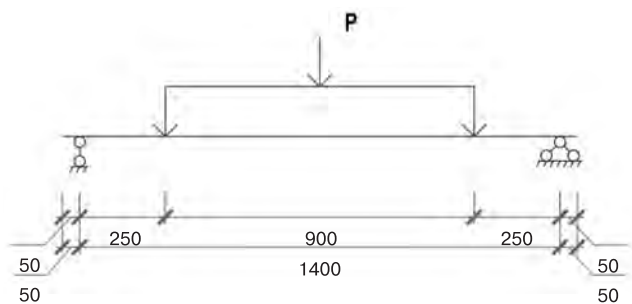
Схема испытаний партий образцов с шифрами 1.1-2; 1.1-4; 1.2-2 и 1.2-4
